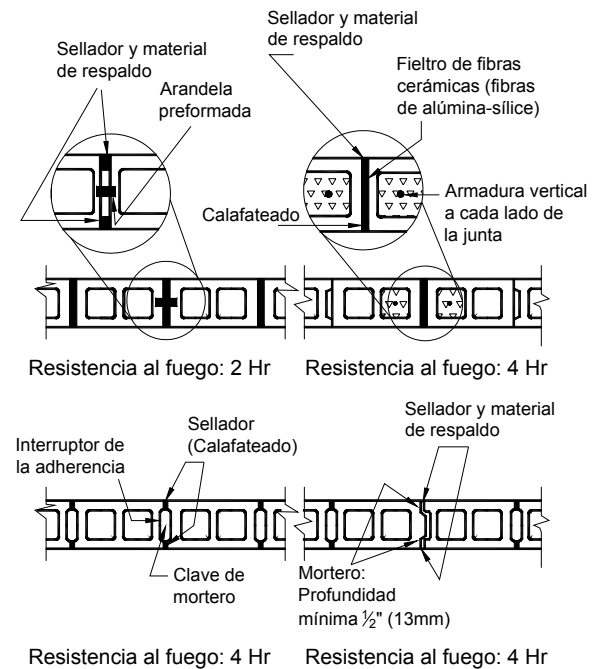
Juntas de expansión o contracción en muros de mampostería con un ancho máximo de 1/2 in. (13 mm) para una resistencia al fuego de 2 ó 4 horas
